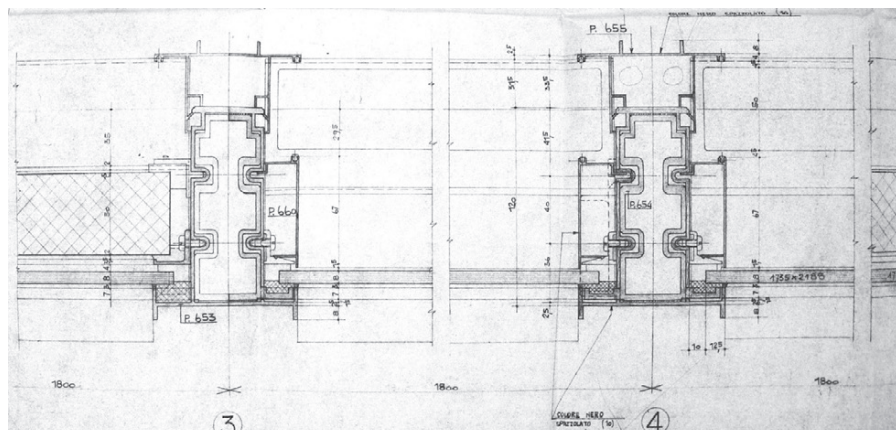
Trancia della sezione orizzontale del curtain wall (ASE)
